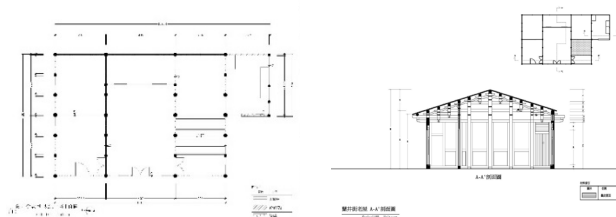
、2 楊宅平面圖 剖面圖 (本研究製圖)
